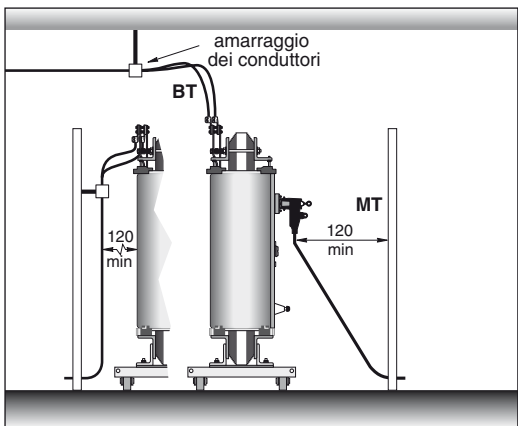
collegamento MT a mezzo di terminali sconnettibili.
